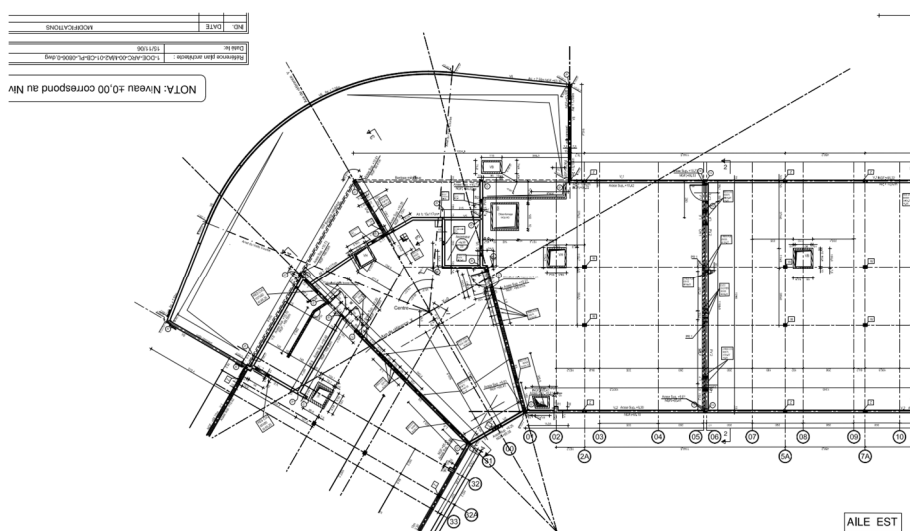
Plan Gros-Cœuvre R+2, bâtiment MA1, DOE
